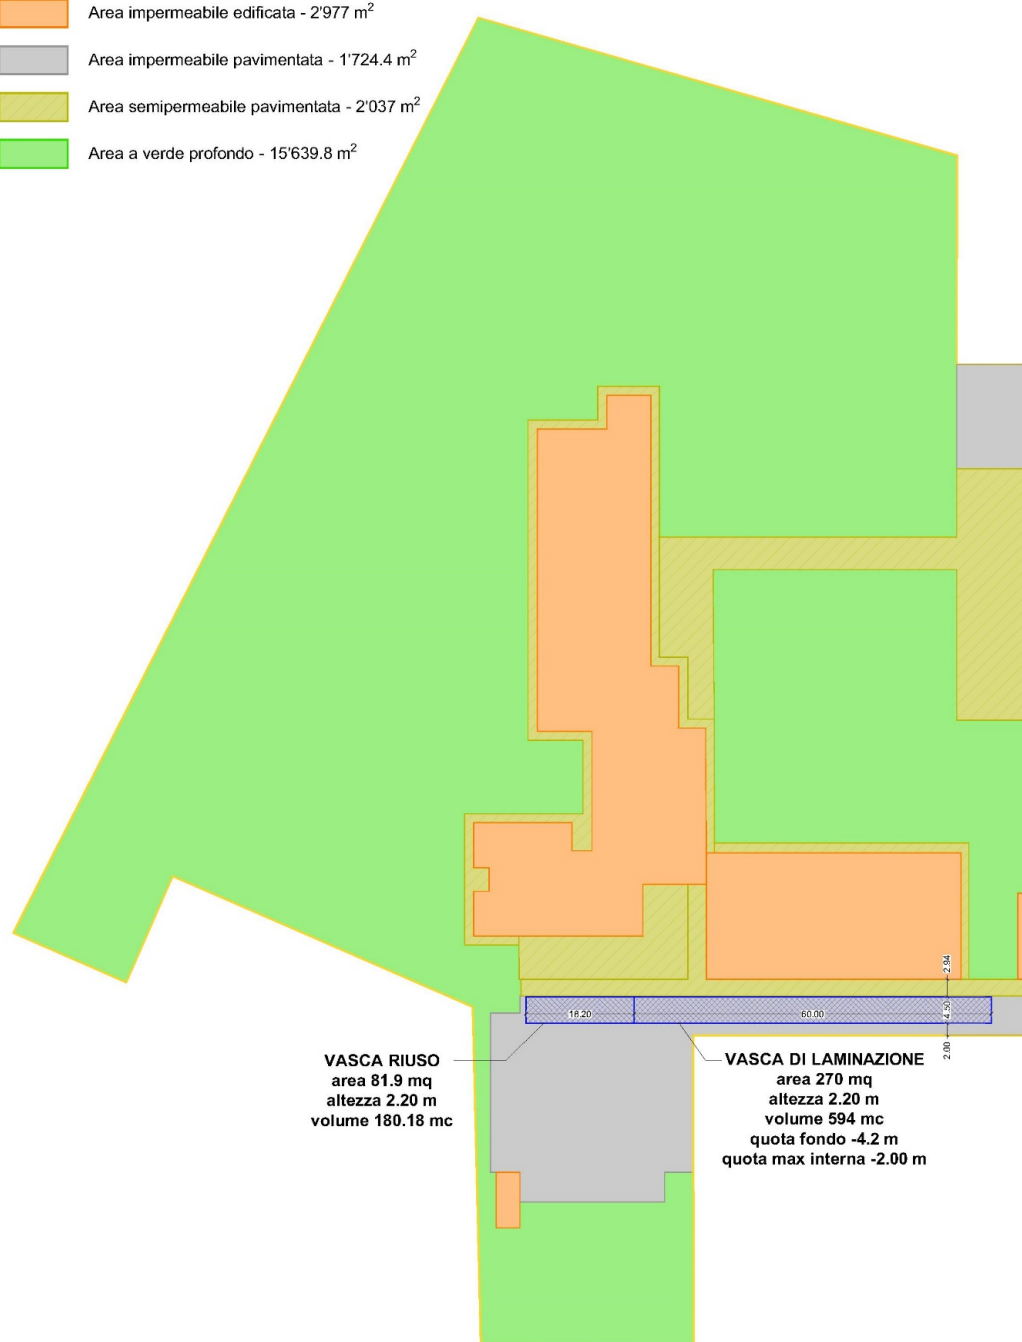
Planimetria area di intervento e divisione in superfici ai fini del calcolo per l'invarianza idraulica
